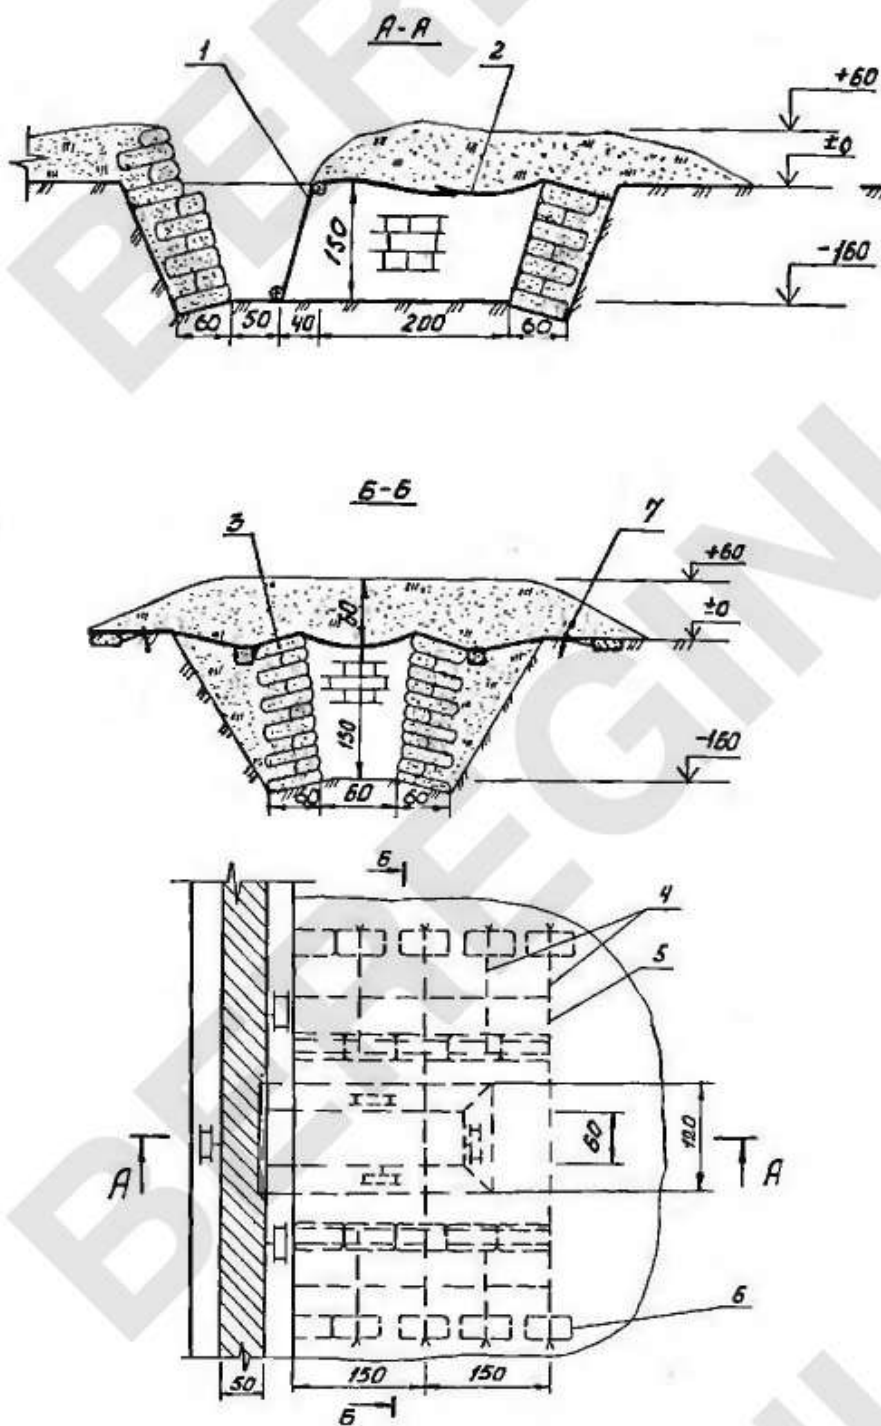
Ніша на 2 людини з одягом крутостей із 3М і перекриттям 3П (брезент, габійонна сітка і т.п.):
